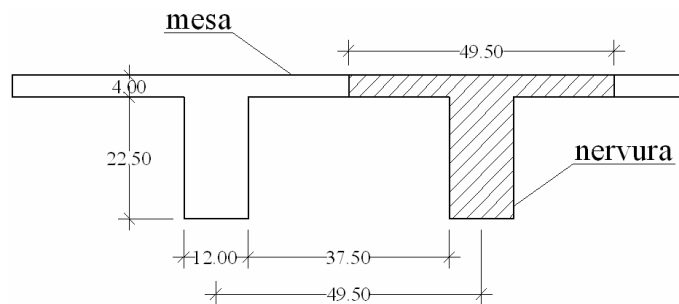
Seção transversal da laje (unidades em centímetros).
